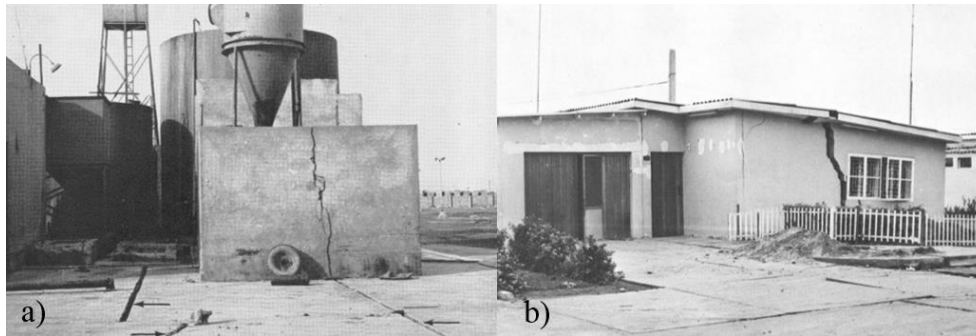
a) Parte de una planta de harina de pescado en puerto Casma severamente agrietada como resultado de la expansión lateral. Pudiéndose notar además el efecto de extensión en las losas de piso de concreto. b) Casa de concreto destrozada por licuefacción y flujo lateral de sedimentos de playa que constituían el material de fundación. Fuente (Ericksen, Plafker, & Fernández-Concha, 1970)
